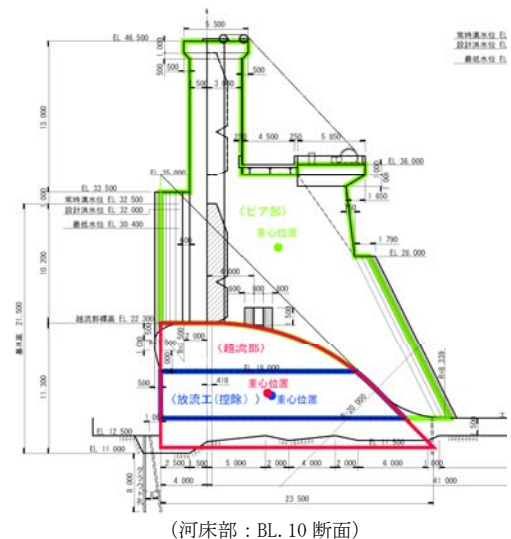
検討断面及び断面位置(右岸スリット施工後)
